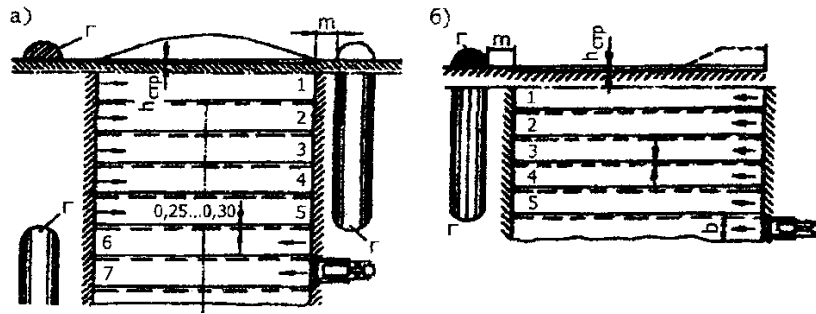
Типовые схемы разработки грунта бульдозером:
